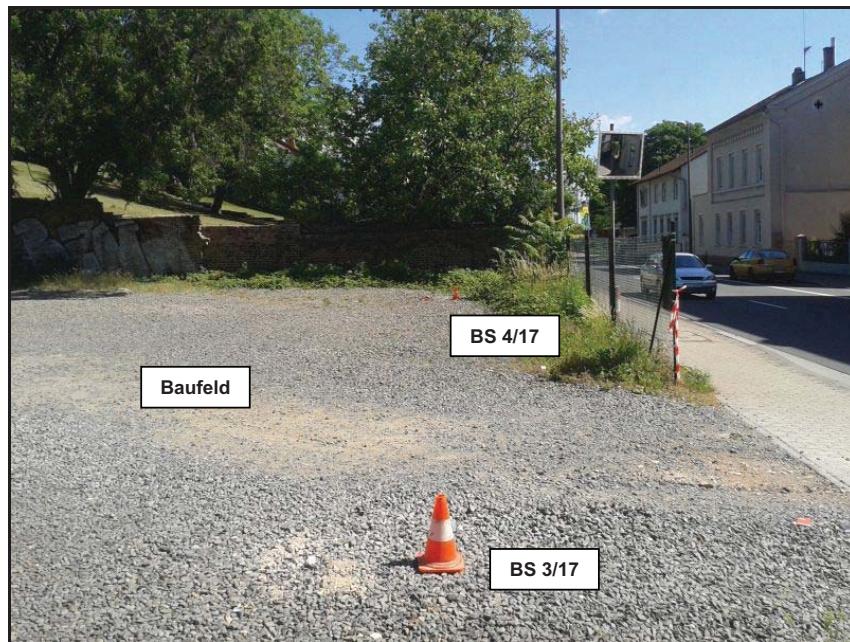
Blickrichtung nach NE auf das Baufeld; Stand: 10.06.-12.06.2017
